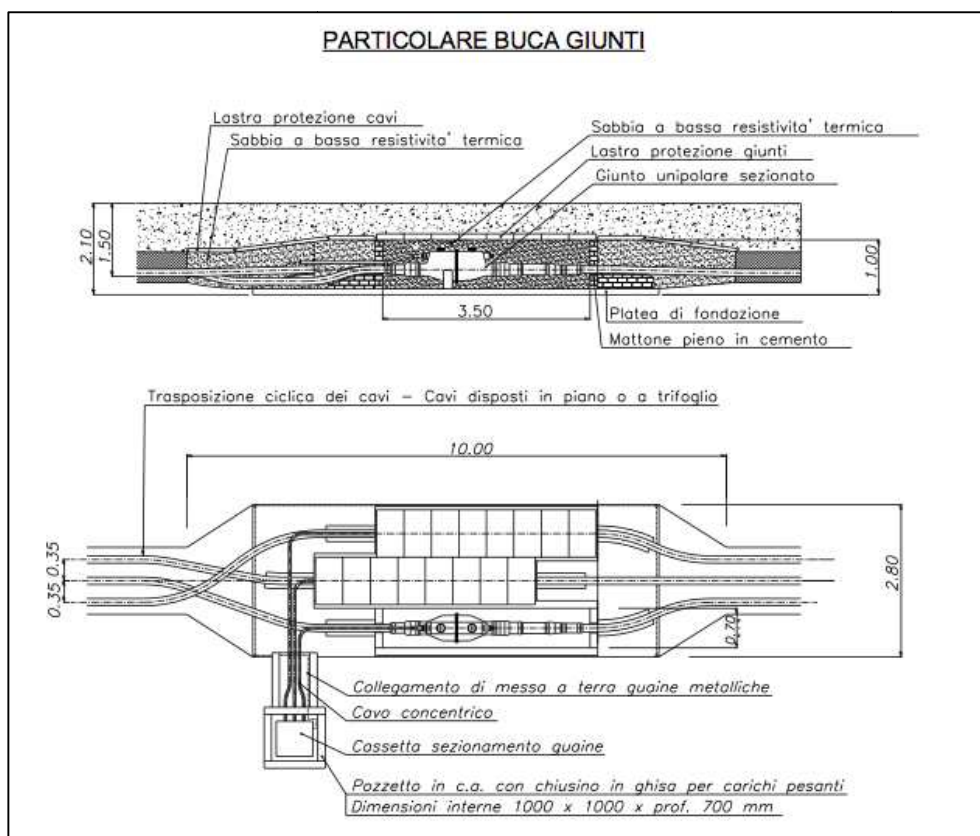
Tipo Camera Giunti: Sezione e Pianta
